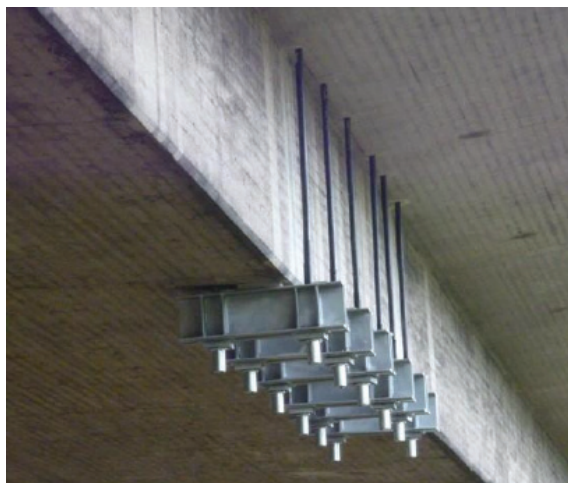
Verankerung von Stabspanngliedern mit einer Stahlkonstruktion – Foto (Erfahrungssammlung Beispiel 2.2)
